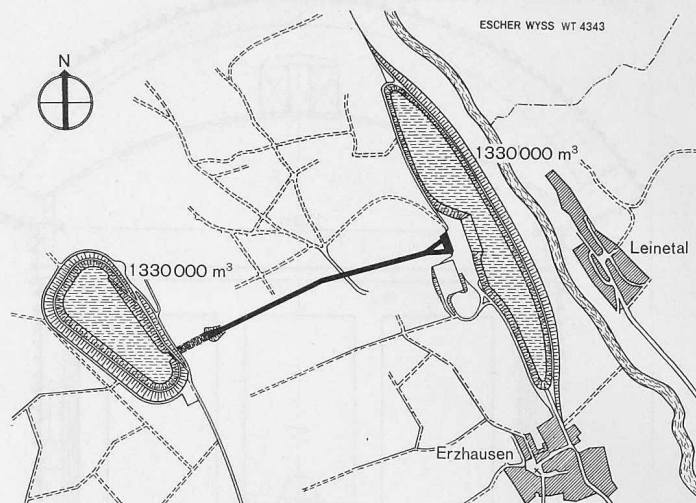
Lageplan des Speicherwerkes Erzhausen an der Leine
